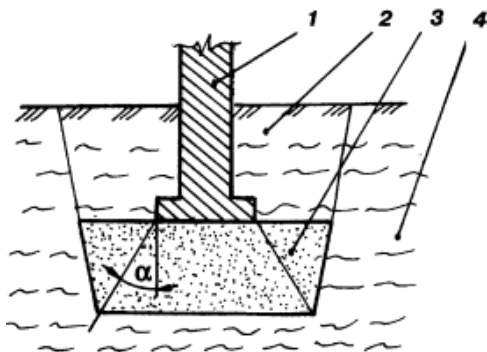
Устройство песчаной подушки, заменяющей слабый грунт:
